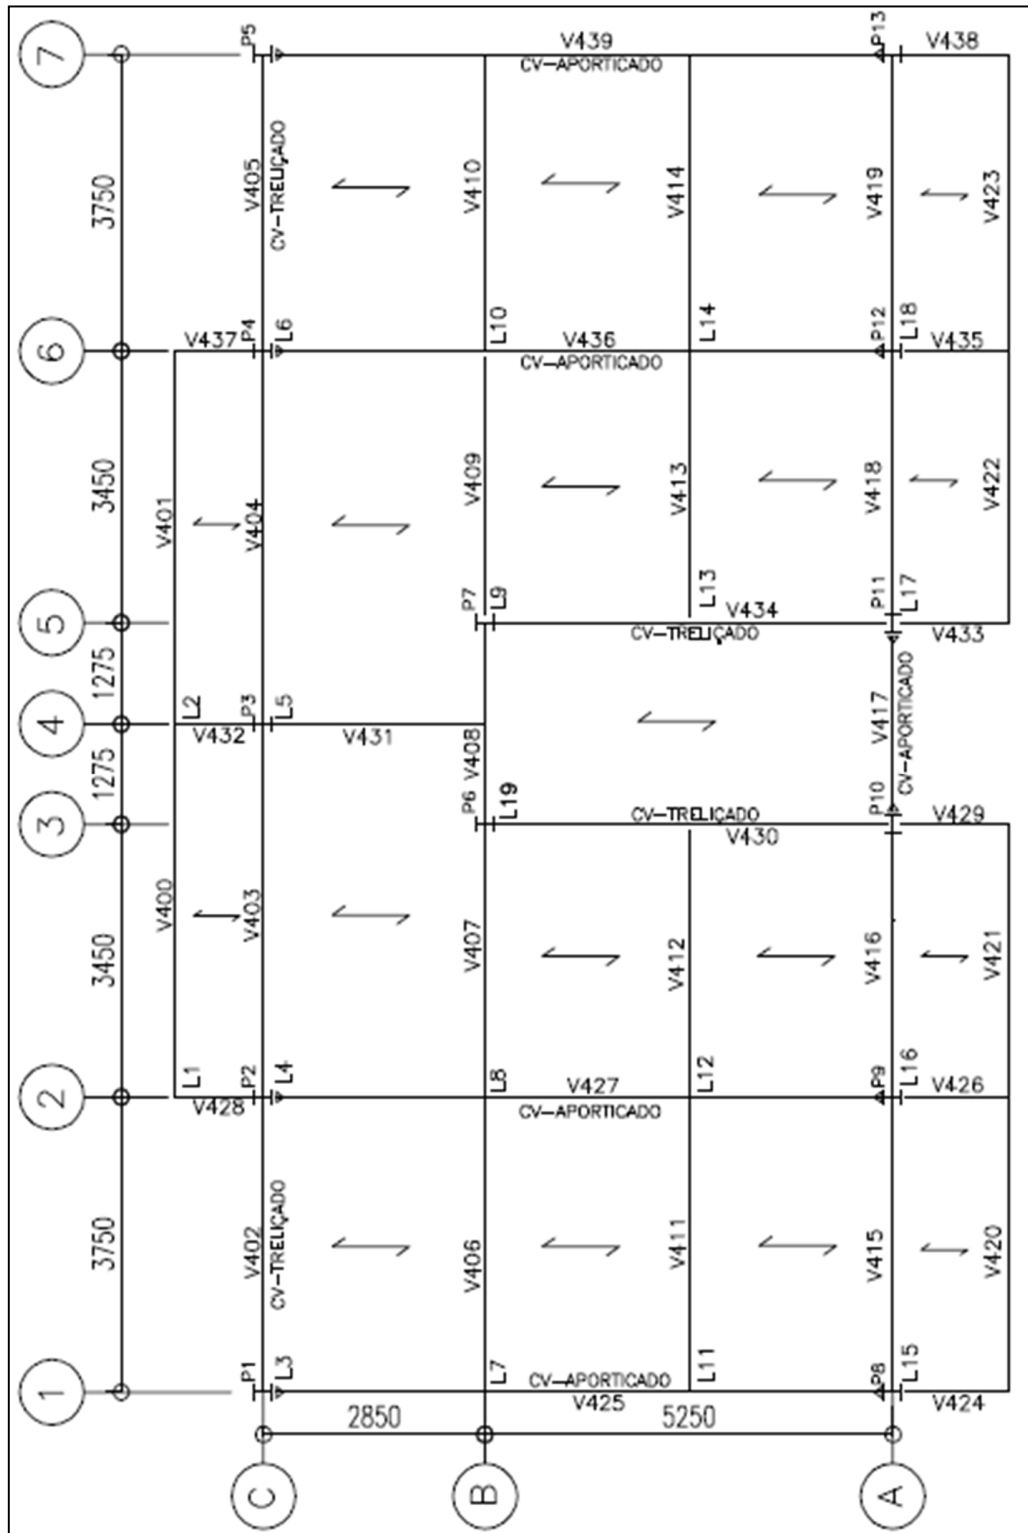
Direções das nervuras dos steel decks no plano das vigas (El. +14000)
